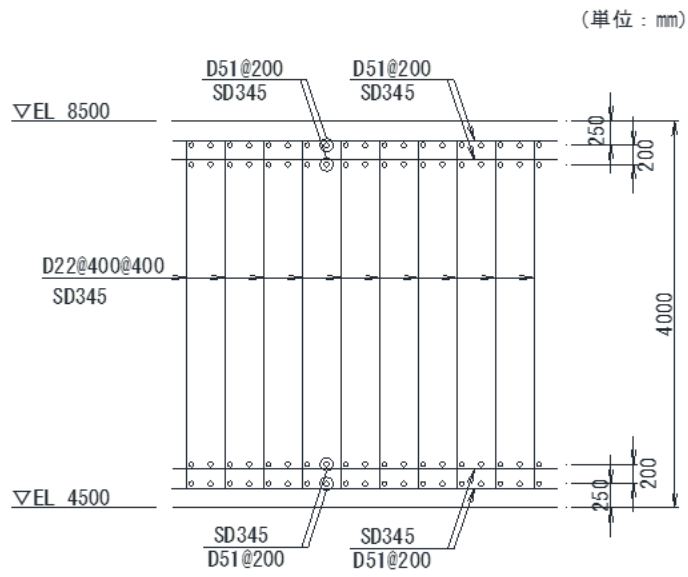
漂流物対策工基礎スラブの概略配筋図 (B-B 断面)
